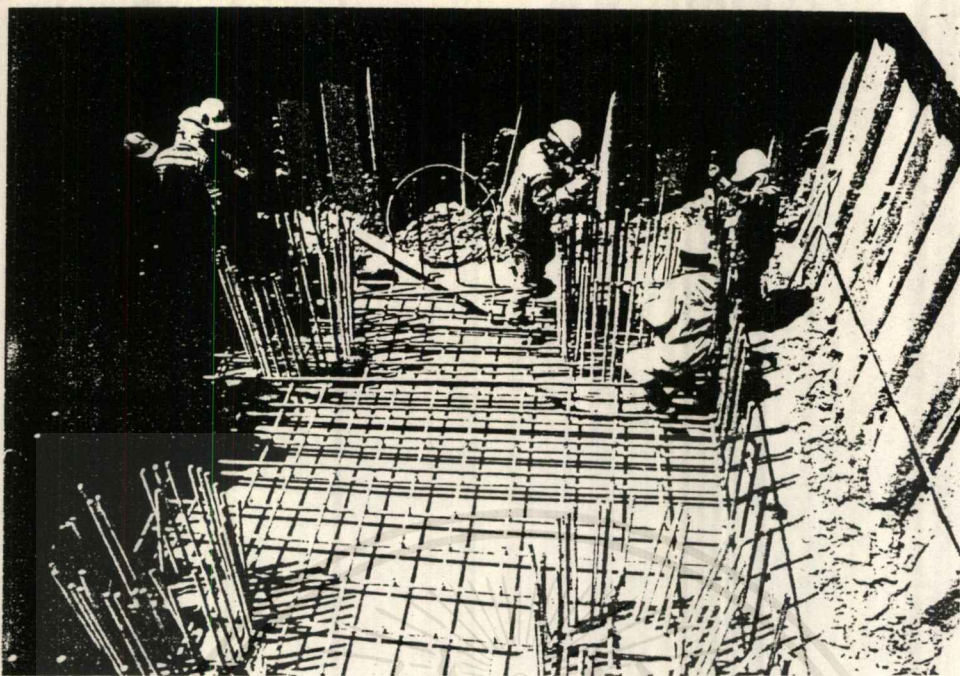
เท Lean Concrete ก้นหลุม
